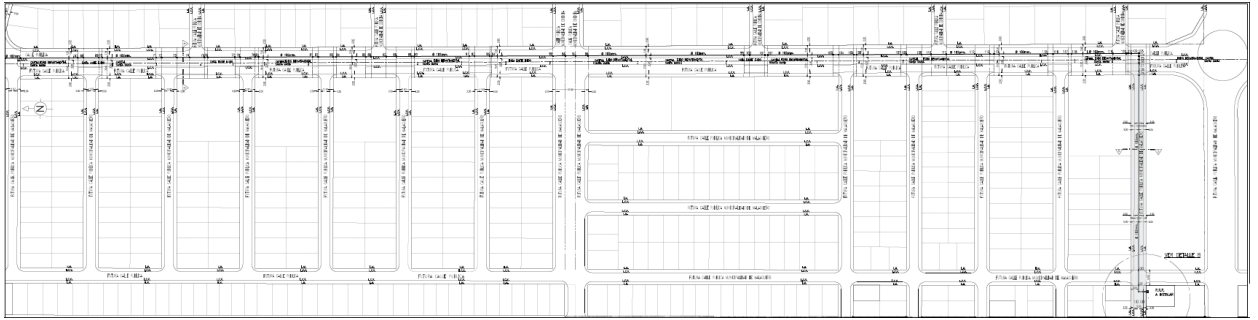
Planimetría del ramal de alimentación (PRP existente hasta Avenida La Donosa).
